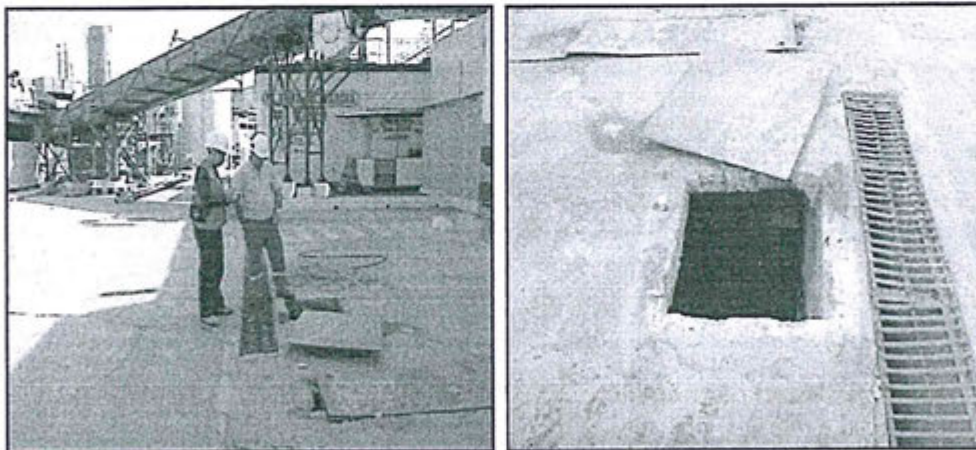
El administrado indicando el punto donde converge el efluente de la nave de proceso y detalle del pozo. No se observa las bombas que trasladarían el efluente de la planta de enlatados hacia la zona "PAMA".
